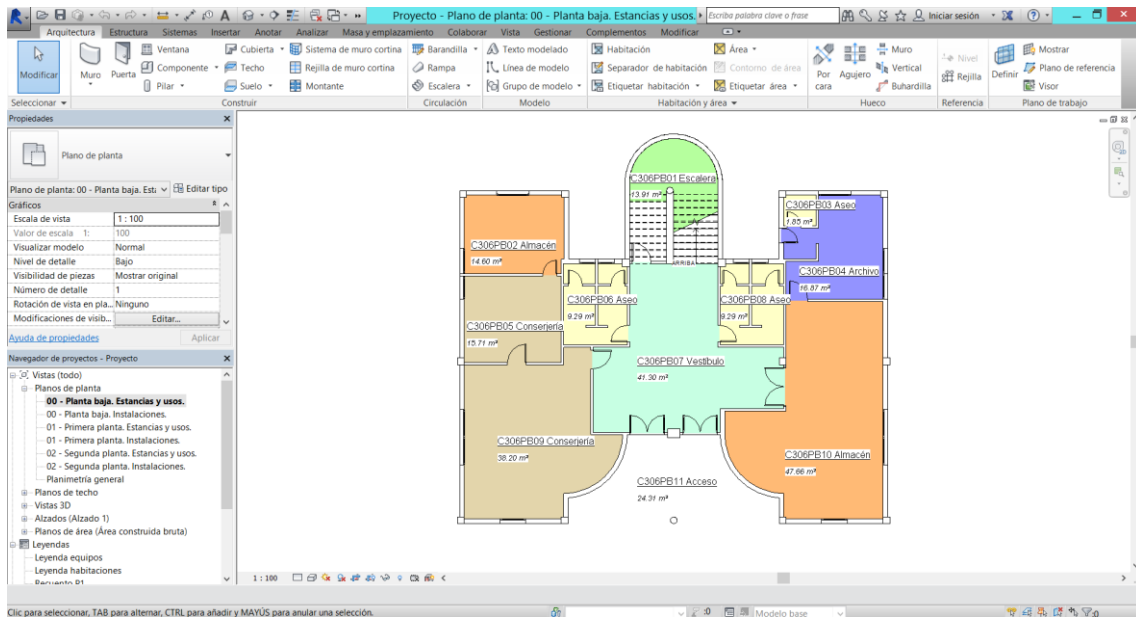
Habitaciones planta baja. Fuente: Elaboración propia
